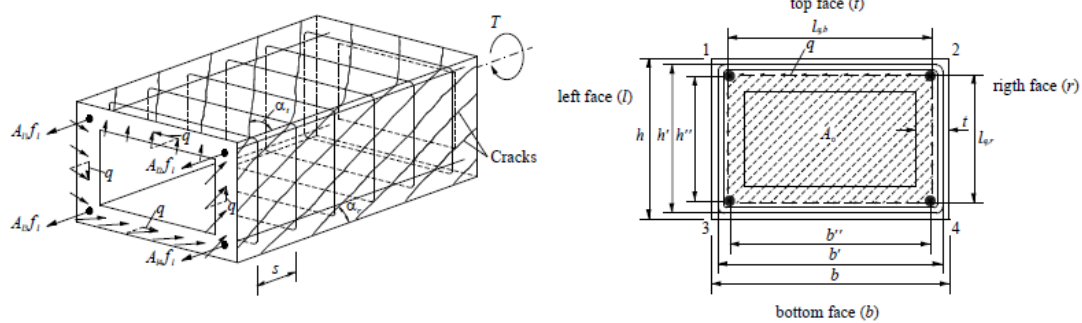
Viga de secção retangular vazada sujeita a torção pura [14]
